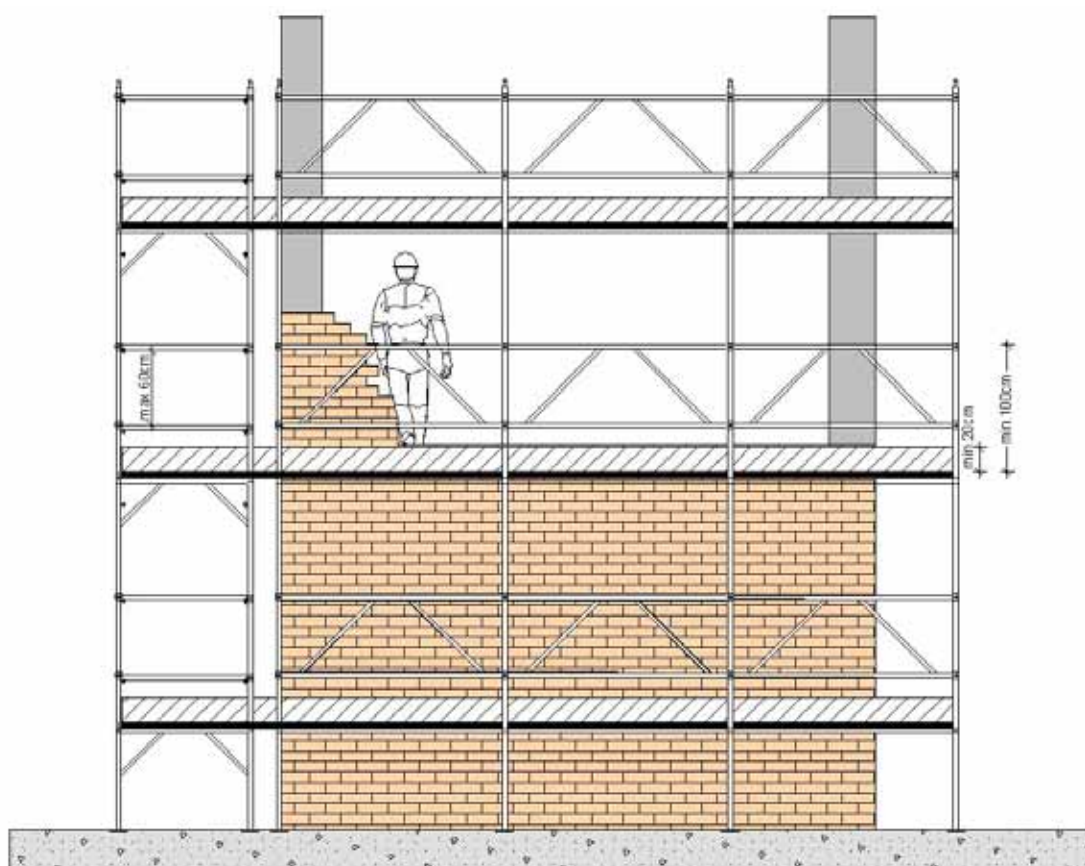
Ponteggio con parapetto alto almeno 1 metro
